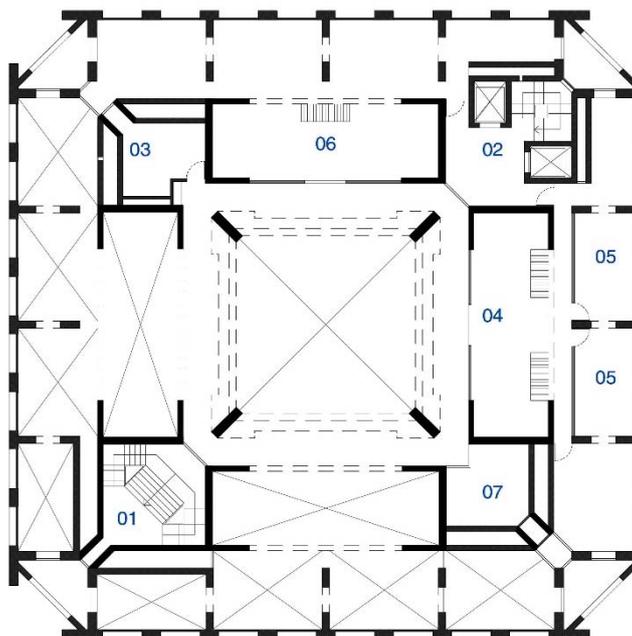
| Planta do terceiro pavimento (mezanino) [redesenho do autor]
